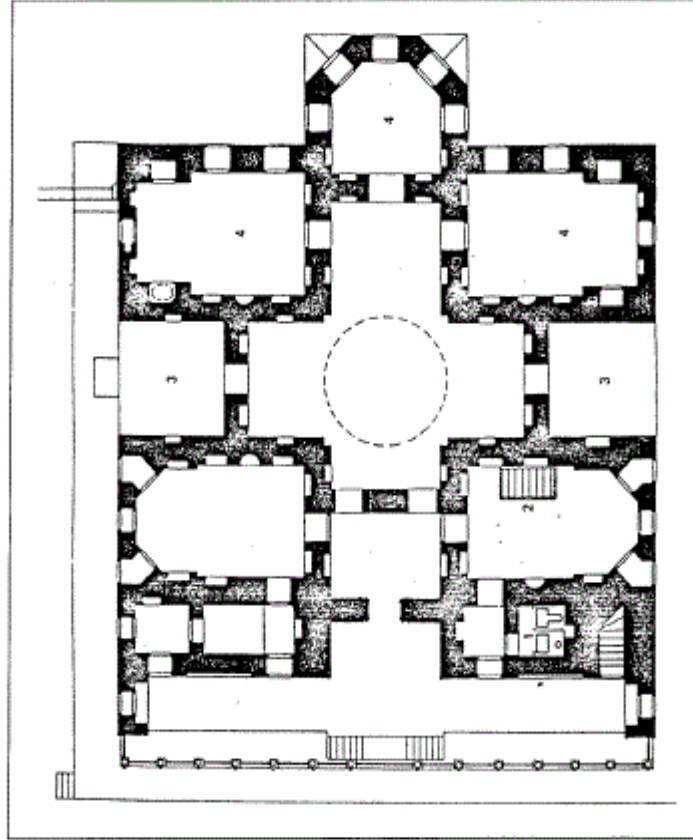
مكرر) مسقط أفقي لطوب قابی سراى باستانبول (عن : جودوين) .
